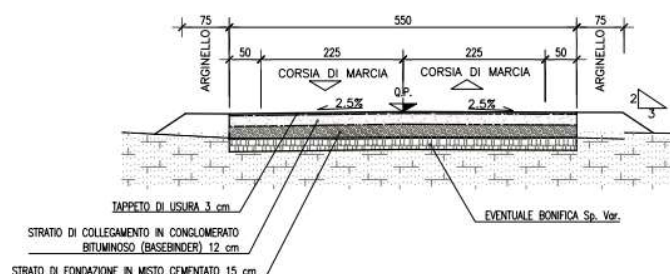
Sezione tipo complanare 5,5 m in rilevato
